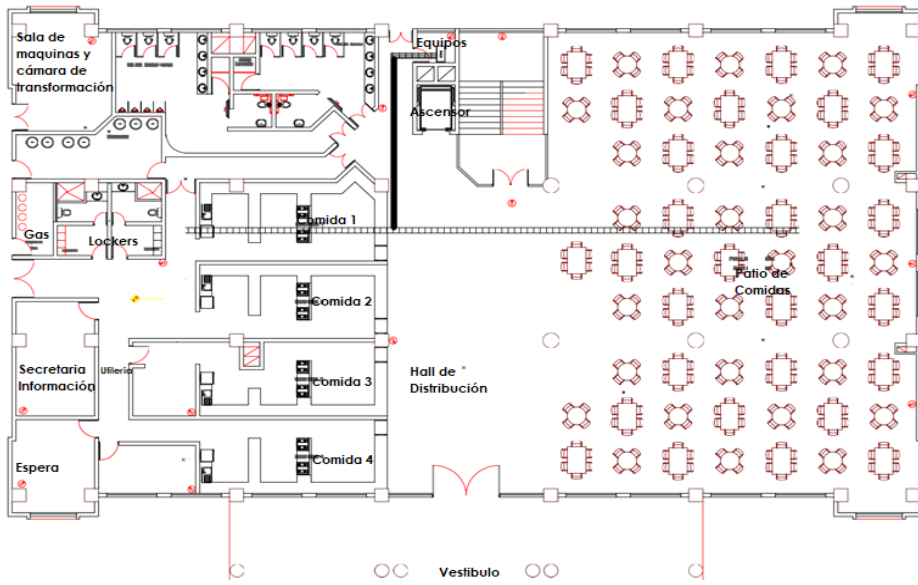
Planos de Infraestructura Subsuelo Edificio Postgrado
